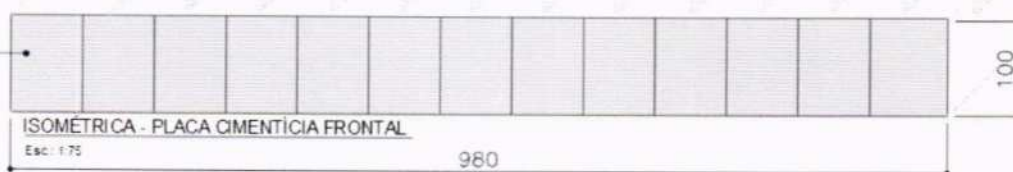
Detalhamento cobertura da fachada da Unidade de Saúde Paulo Kondo em Placas cimentícias.
